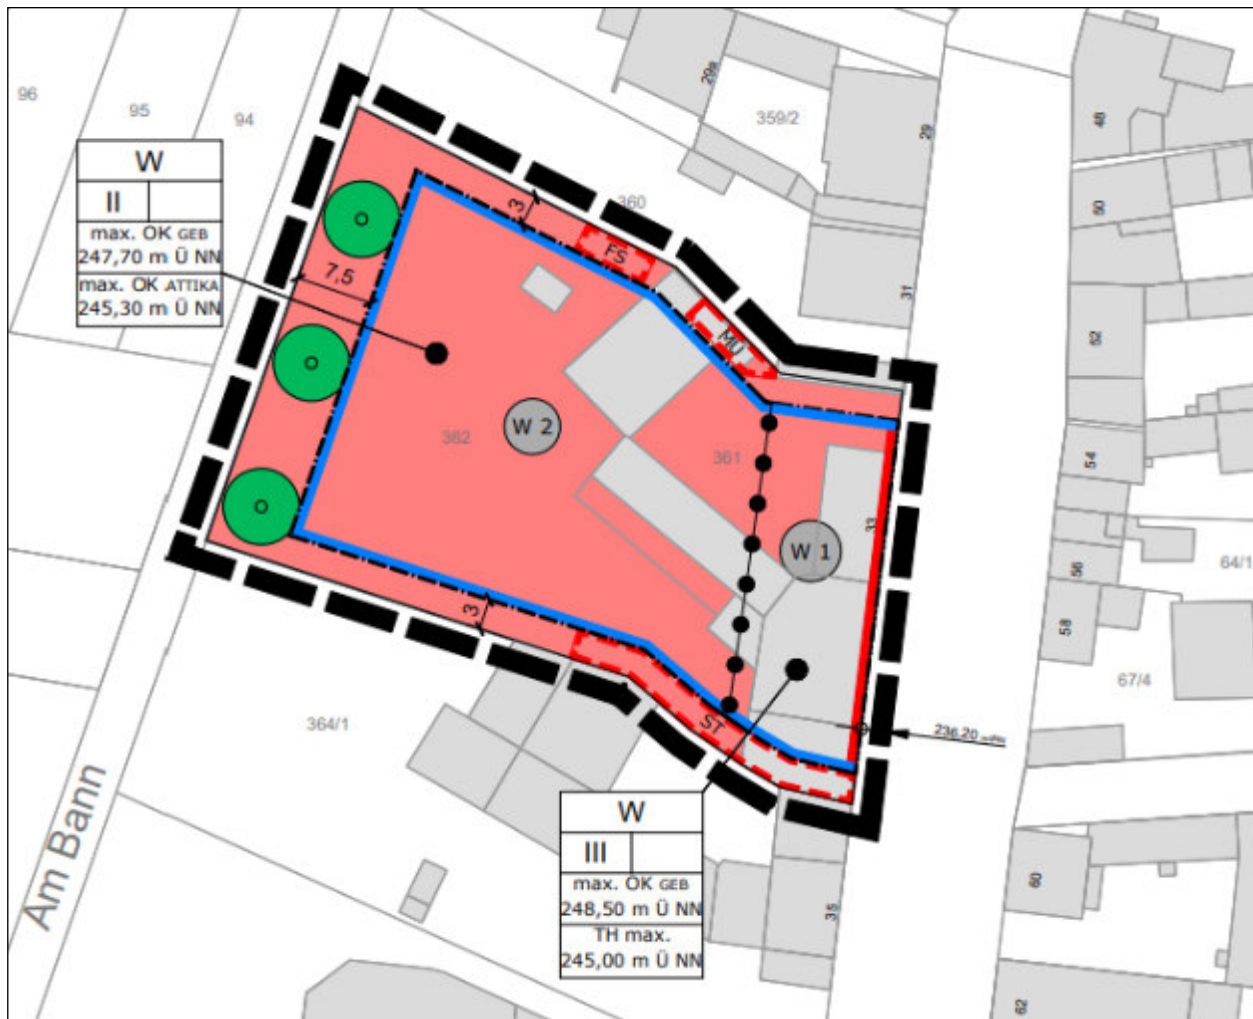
Ausschnitt aus dem vorhabenbezogenen Bebauungsplan „Hauptstraße 33“, Stadt Butzbach, Stadtteil Kirch-Göns, Quelle: PlanEs, Elisabeth Schade, Städtebauarchitektin und Stadtplanerin, AKH. Stand: 13.11.2020.
